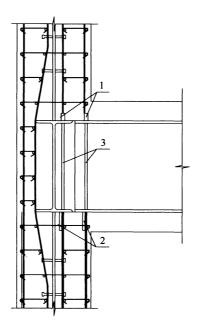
墙体竖向钢筋遇型钢梁的连接做法 1-钢筋连接套筒;2-连接板;3-加劲肋
